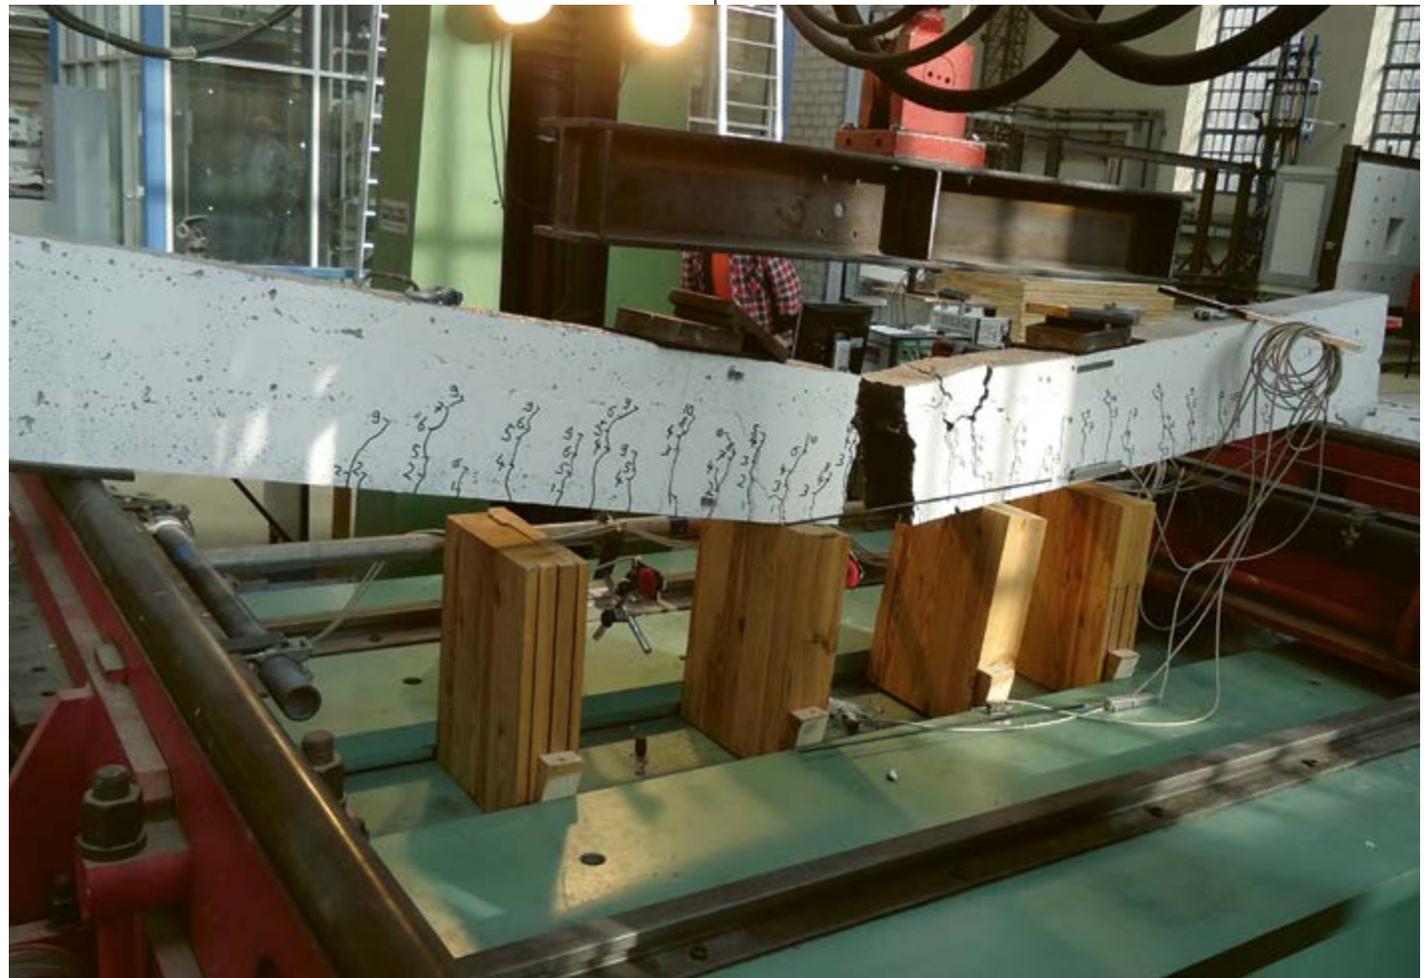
4-Punkt-Biegeversuche am Infraleichtbeton-Balken nach Versagen der Bewehrung
